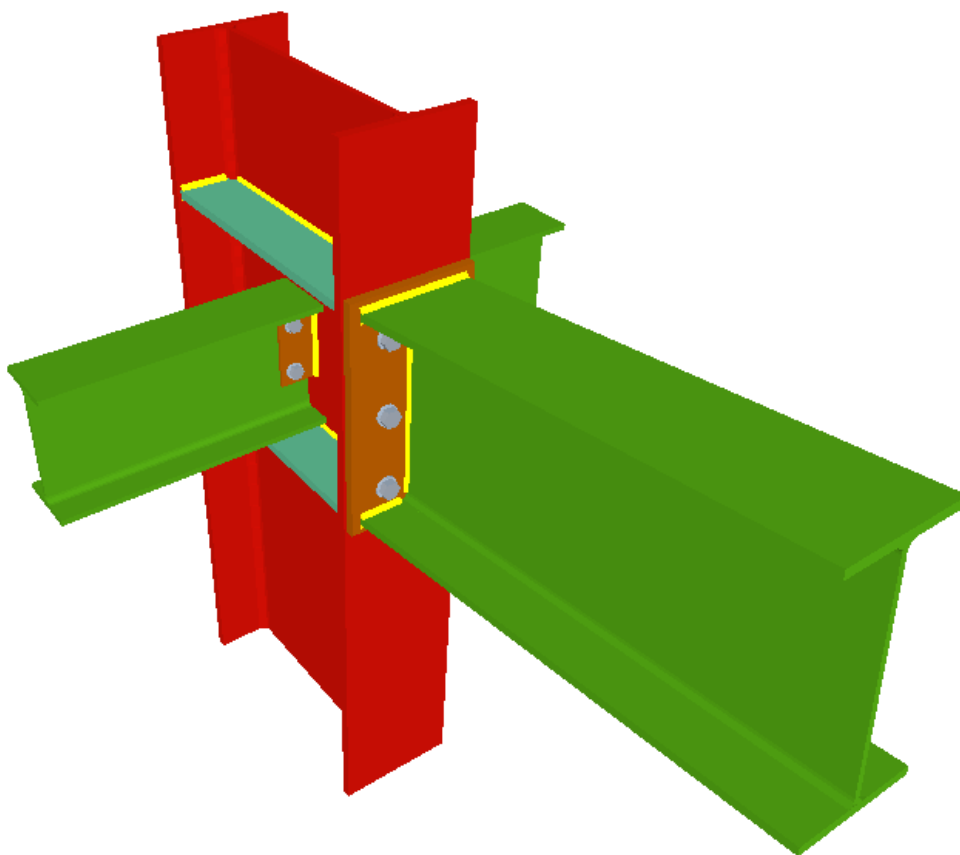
Ejemplo de unión viga-pilar con placas soldadas en fábrica y atornilladas en obra
